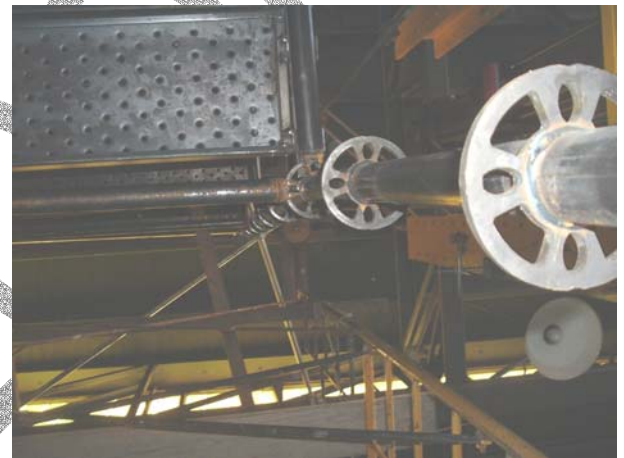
Vista general de montaje de ensayo de carga a barandas.
